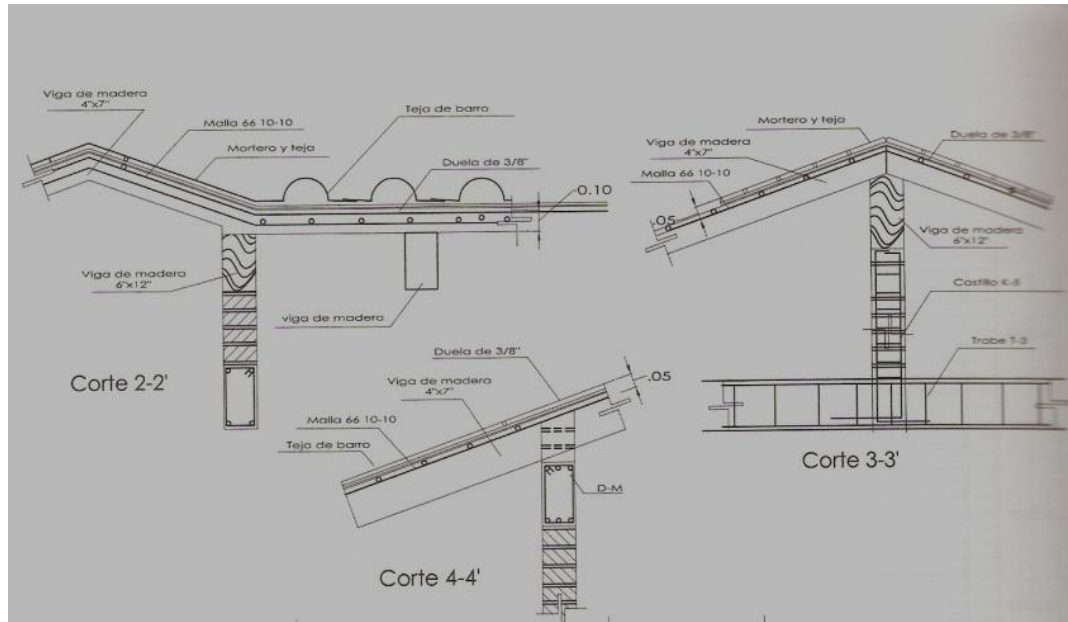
Cortes por fachada de detalles estructurales, albañilería y acabados.<sup>67</sup>
